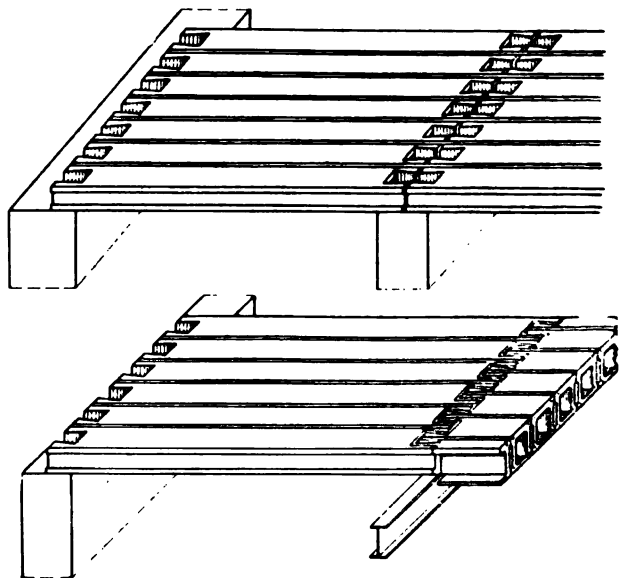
Anker-Betonbalkendecke auf Mauern und auf I-Trägern aufliegend.
